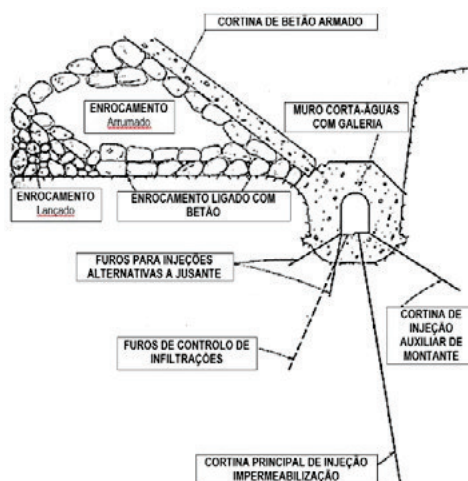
Geometria do muro corta-águas, da galeria de fundação e das cortinas de injeção
